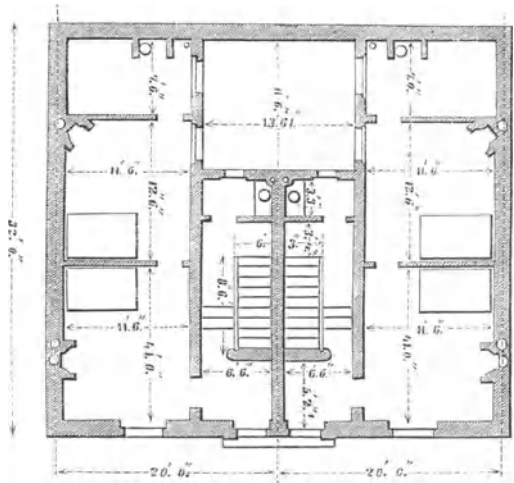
Grundriß des Arbeiterhauses nach dem Modell Napoleon's III.
